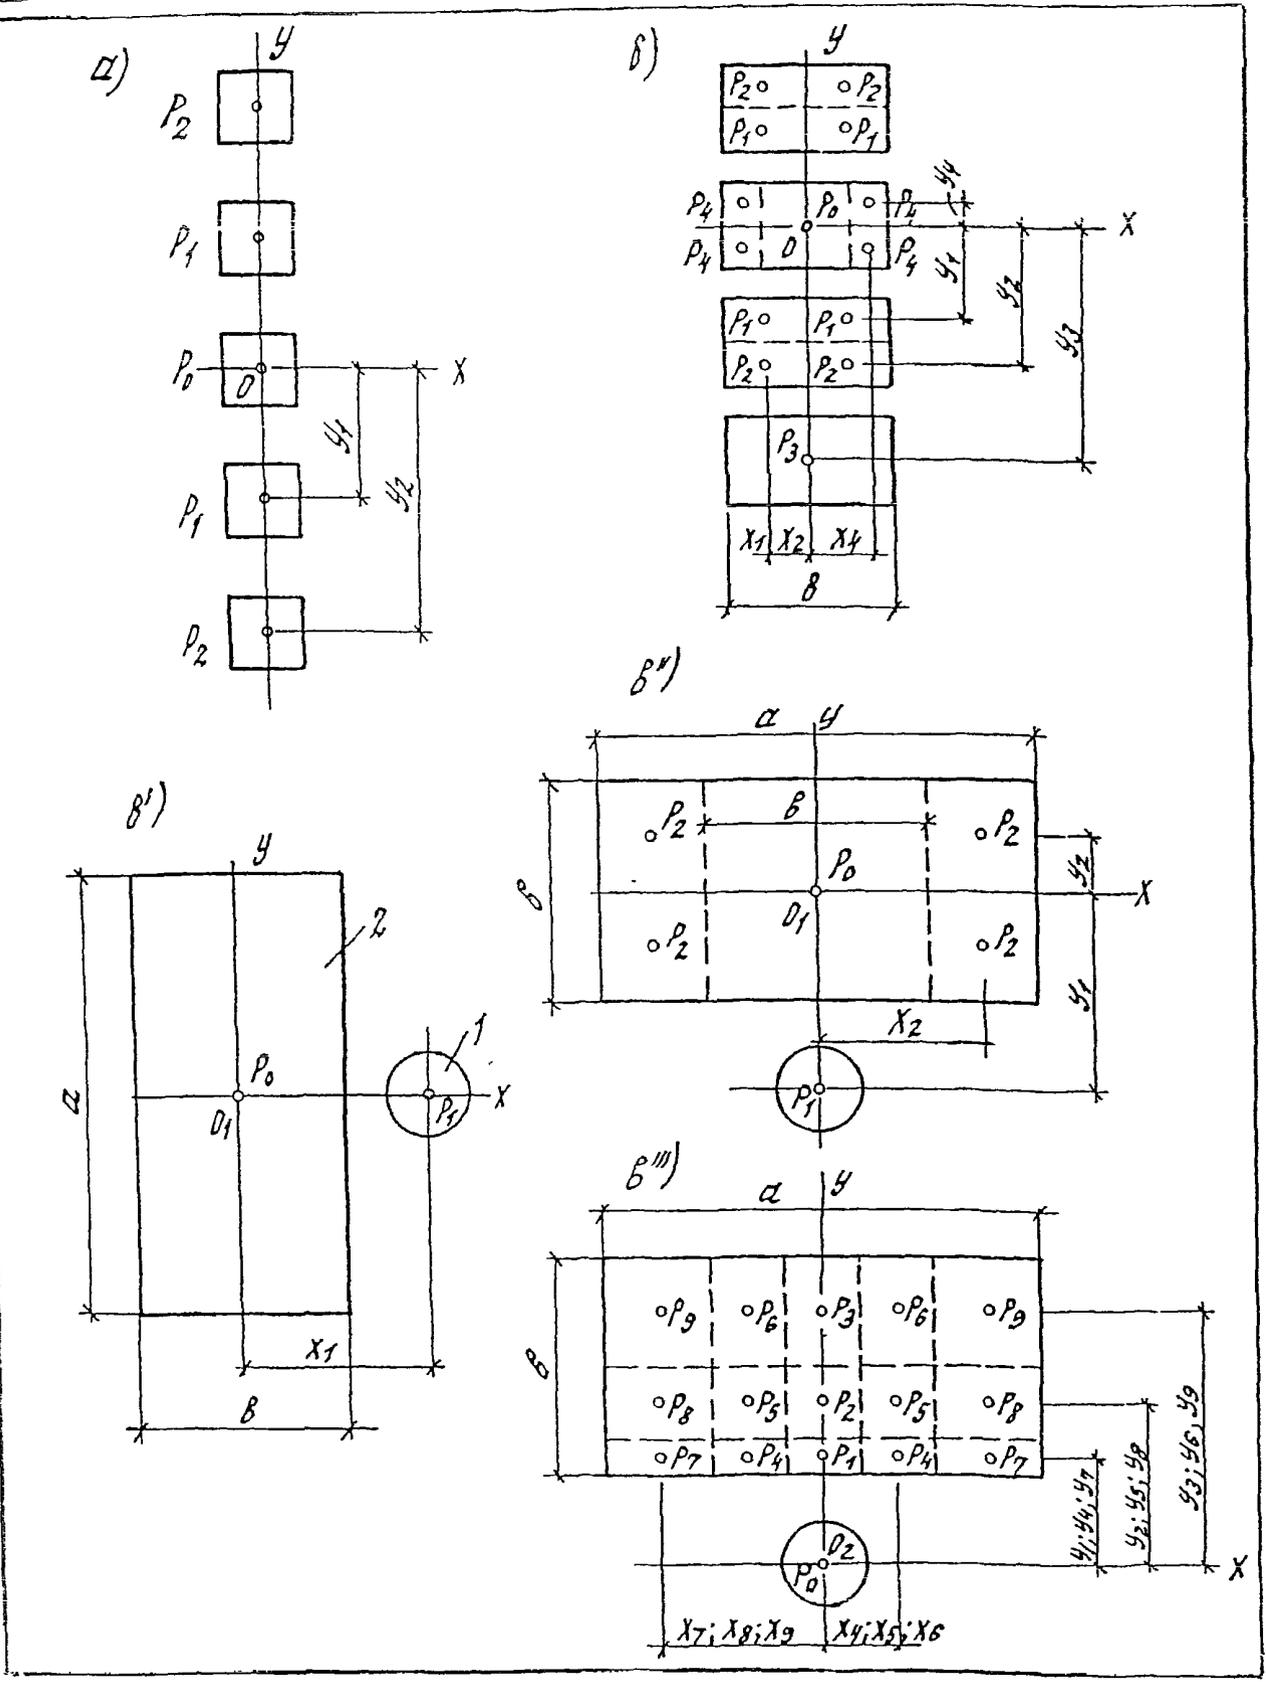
Схема расположения в плане нагрузок сложного вида, расчетного центра O , осей координат и разделения следов нагрузок на элементарные площадки
